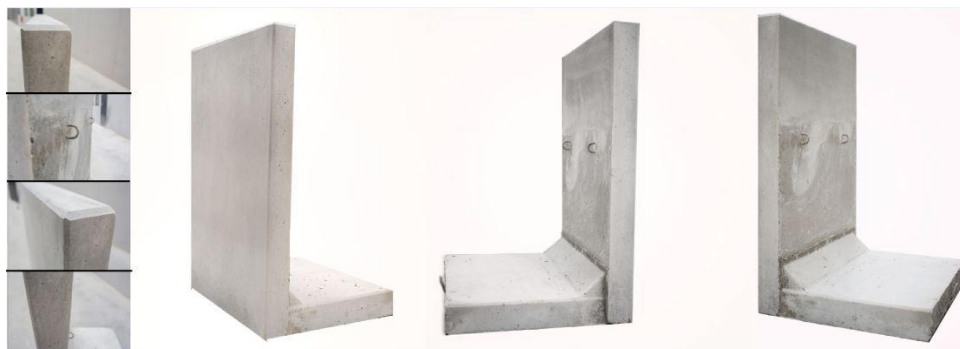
Prefab. ścianka czołowa przepustu pod zjazdem – wariant 1
